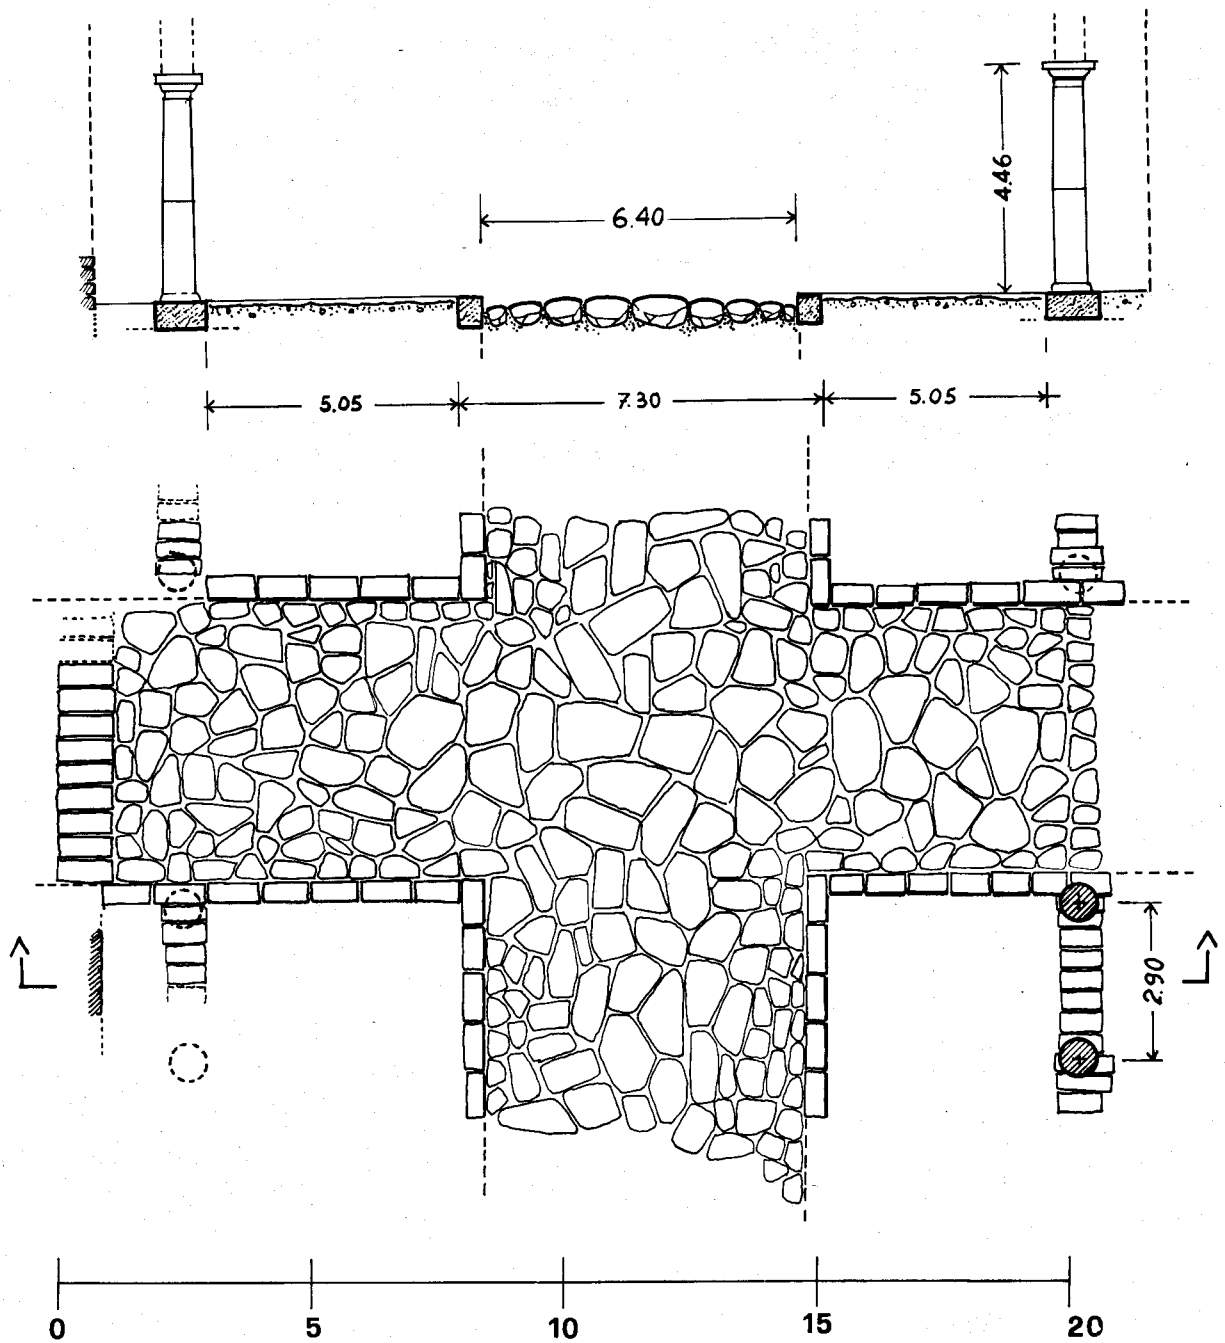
Schema ricostruttivo del tracciato stradale con colonnati e diverticoli.
